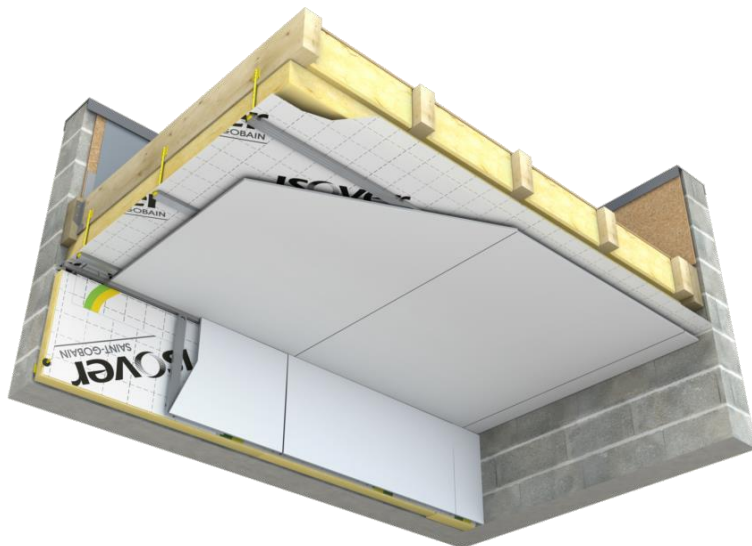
Jonction du mur et du plafond avec finition plaque de plâtre.
